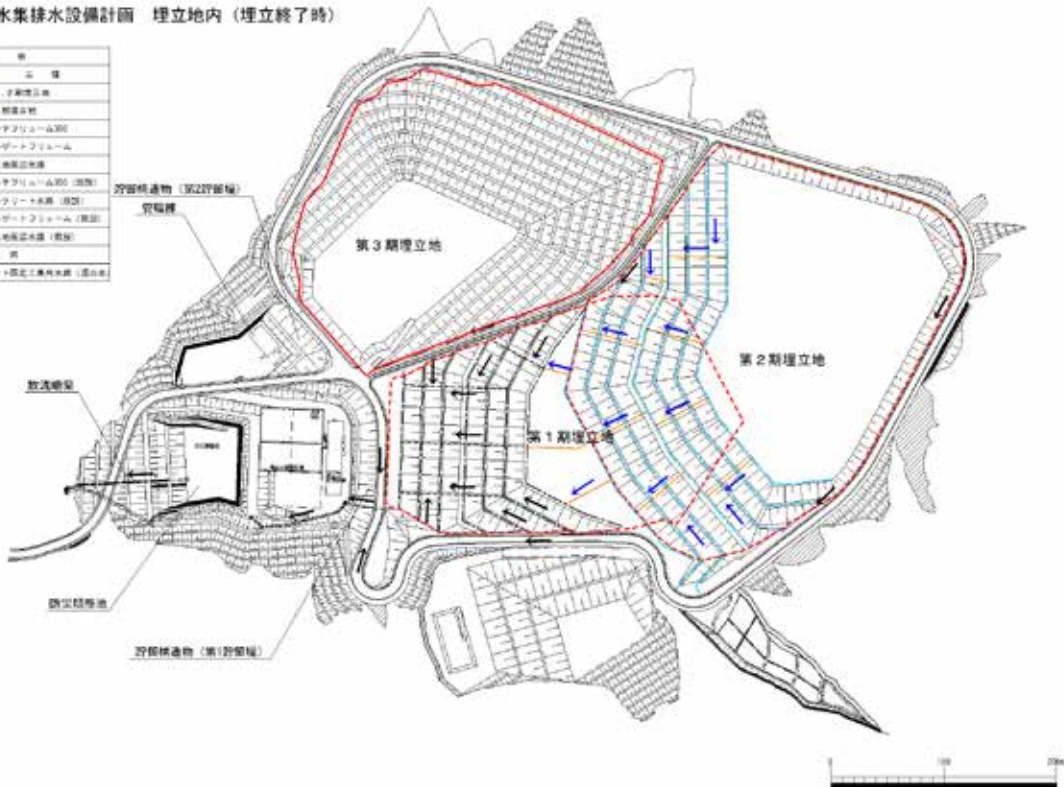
雨水集排水設備配置図 第2期埋立終了時
